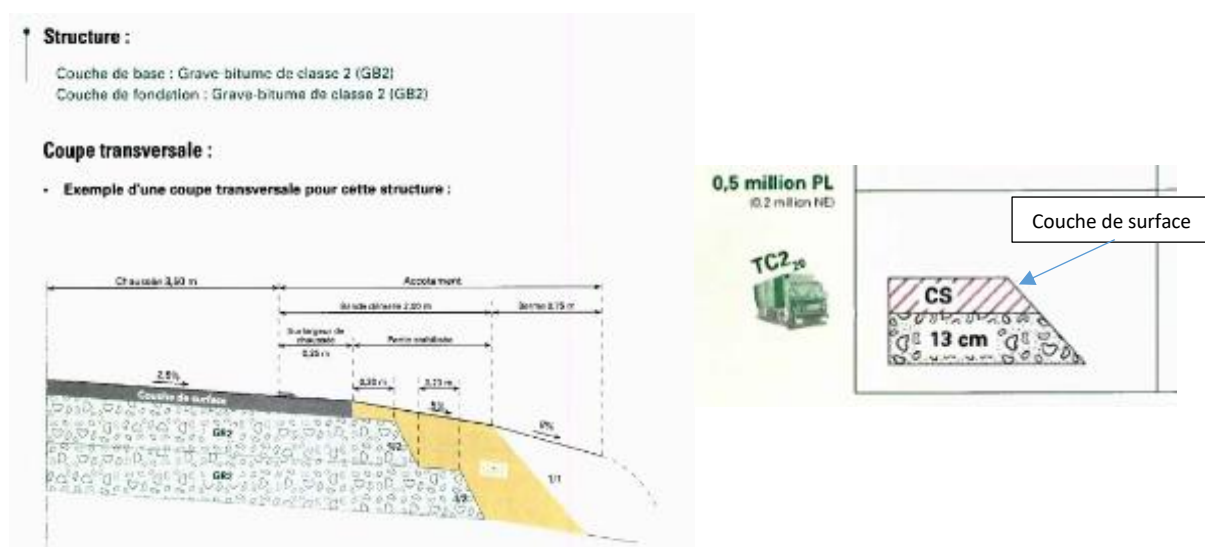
Structure de chaussée envisageable sur le site projet : structure GB2 / GB2
